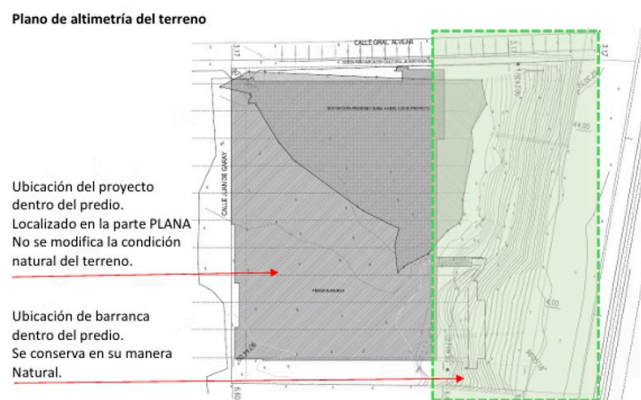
Plano de altimetría del terreno. Fuente: Proyecto de Impacto Ambiental, Expediente N° 158/2026. (Página 5 del proyecto de impacto ambiental, se observa en gris una zona que el desarrollador denomina como "la parte PLANA" cuando en realidad existe una diferencia de cota (alturas) superior al metro. En la parte verde se puede apreciar un sector rectangular donde estar implantada una piscina de uso común que afecta directamente a la barranca)
